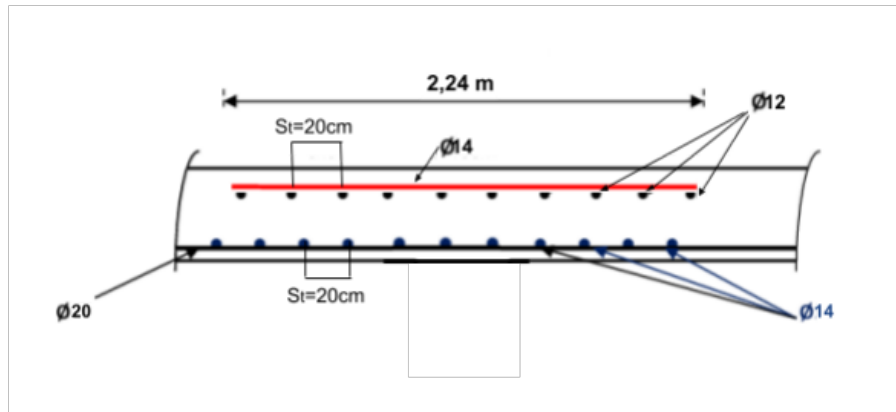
ferrailage sur une coupe transversal entraxe d'une poutre
